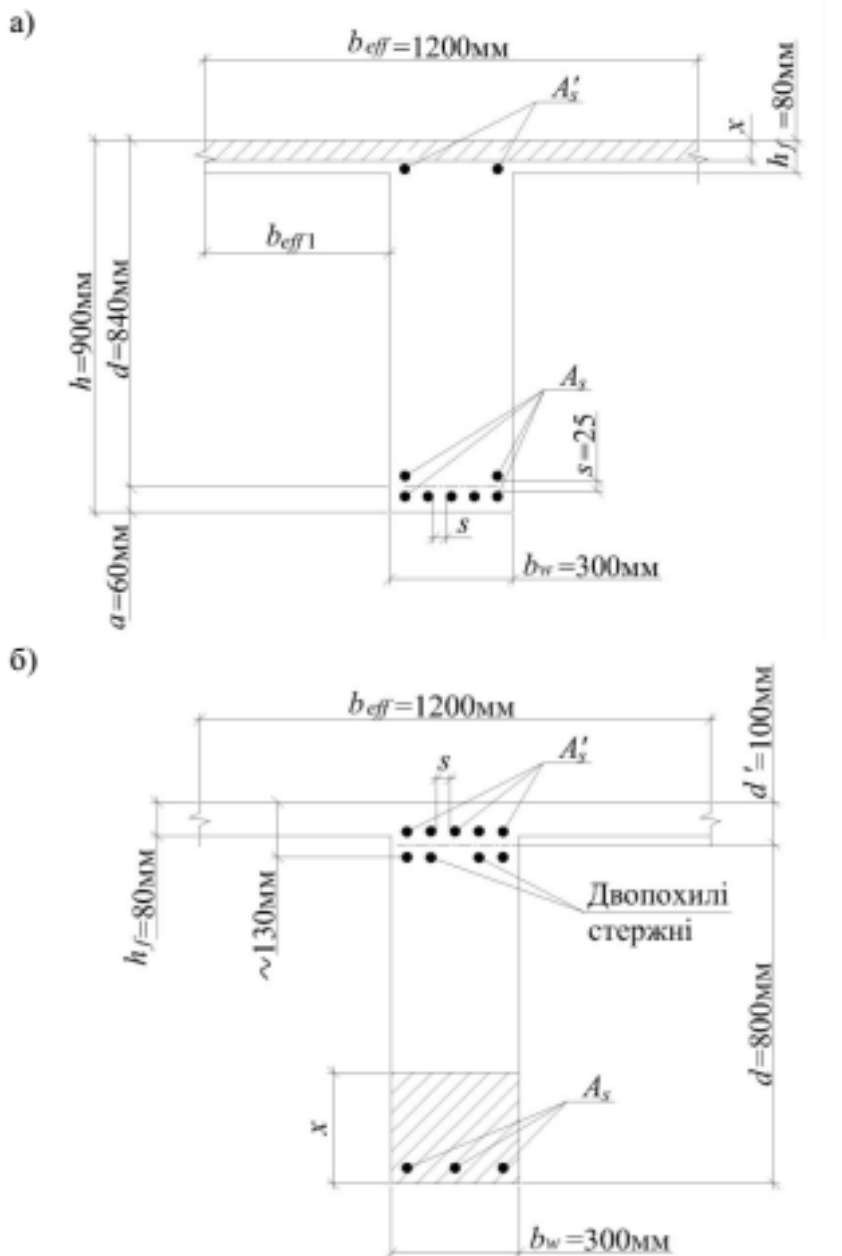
Розрахункові перерізи головної балки (перший проліт): а) у прольоті; б) на опорі
